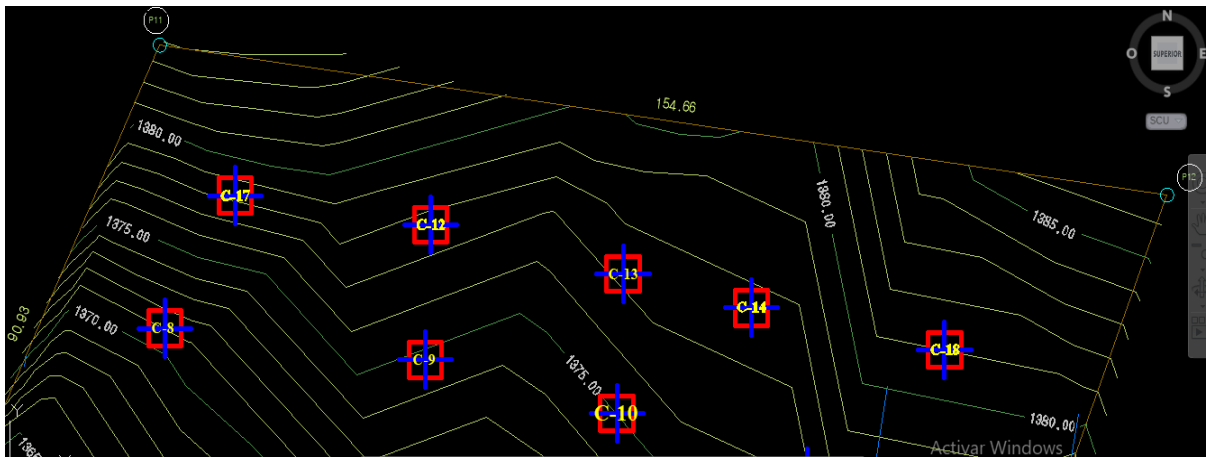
Plano de Detalles de Ubicación de Calicatas
